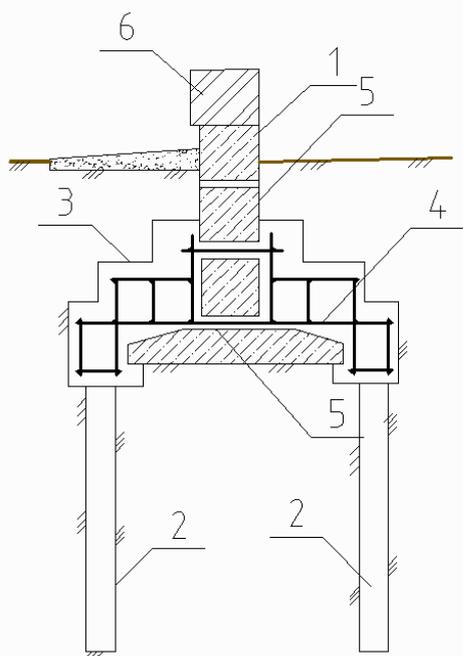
Усиление ленточных фундаментов передачей нагрузки на сваи: 1 – усиливаемый ленточный фундамент; 2 – буронабивные железобетонные сваи; 3 – железобетонная обойма; 4 – основная рабочая арматура усиления; 5 – отверстие проделываемое в швах между фундаментными блоками; 6 – кирпичная стена
